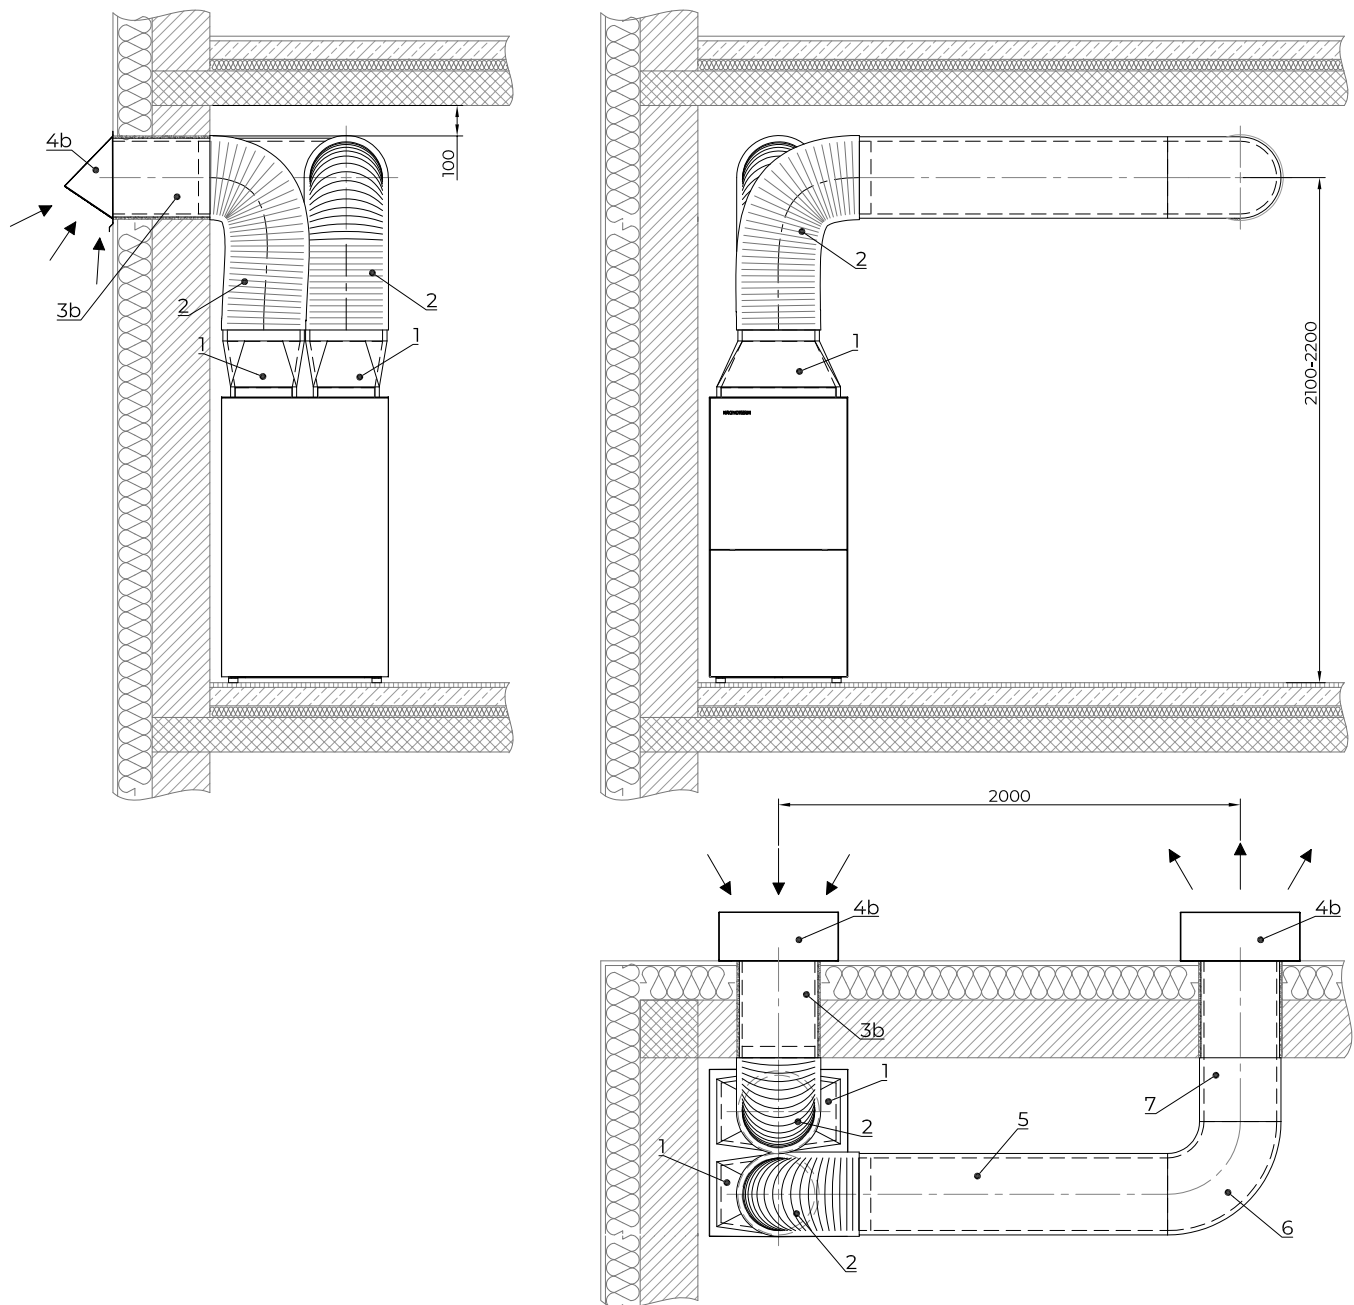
Bijlage 17_a - Plan voor het installeren van het gevelementrooster
